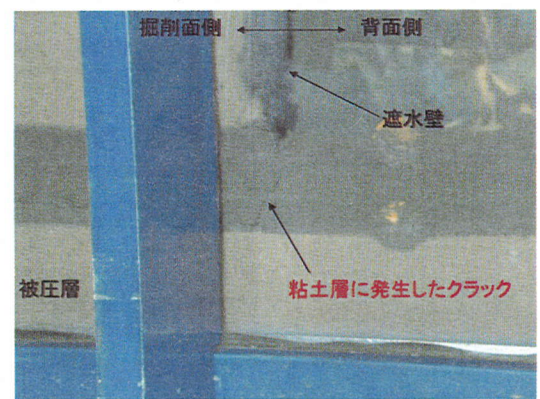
粘土層に見られた縦方向のひび割れ状況
